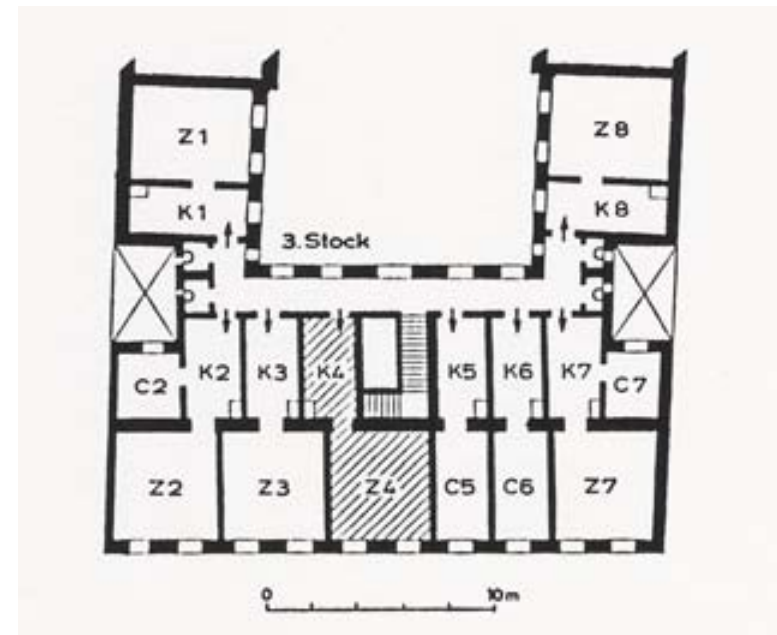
Grundriss eines Arbeitermiethauses der Hochgründerzeit mit Gangküchenanordnung
